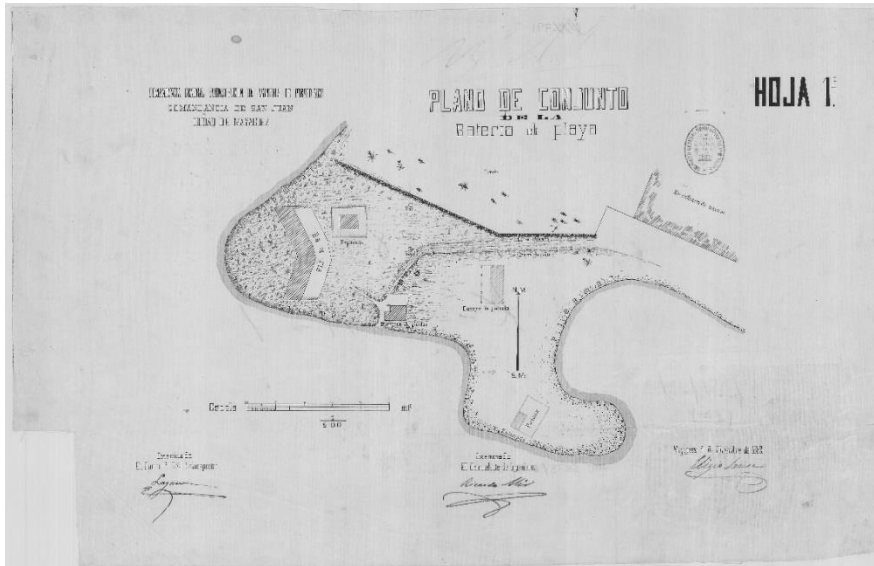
Plano de conjunto de la batería de la playa. AGMM, Cartoteca, sig. PRI-18/6
